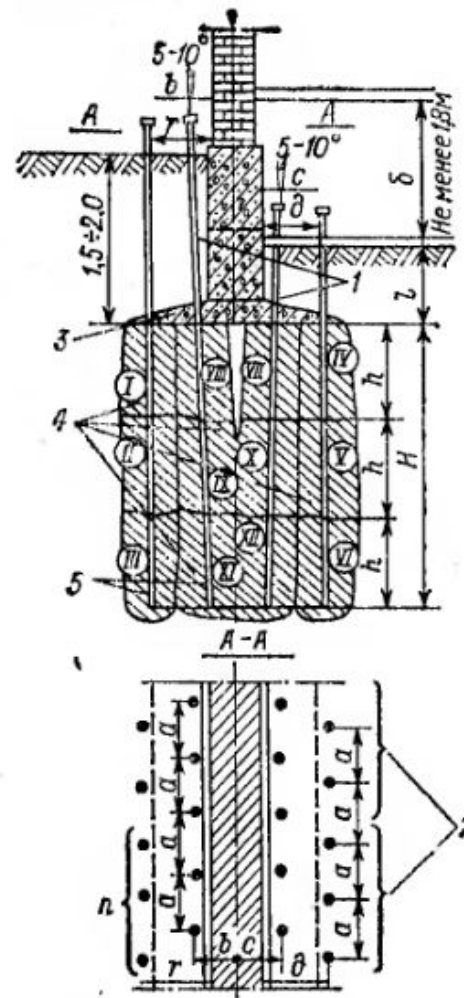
Размещение инъекторов при закреплении грунта под широкими сборными фундаментами
